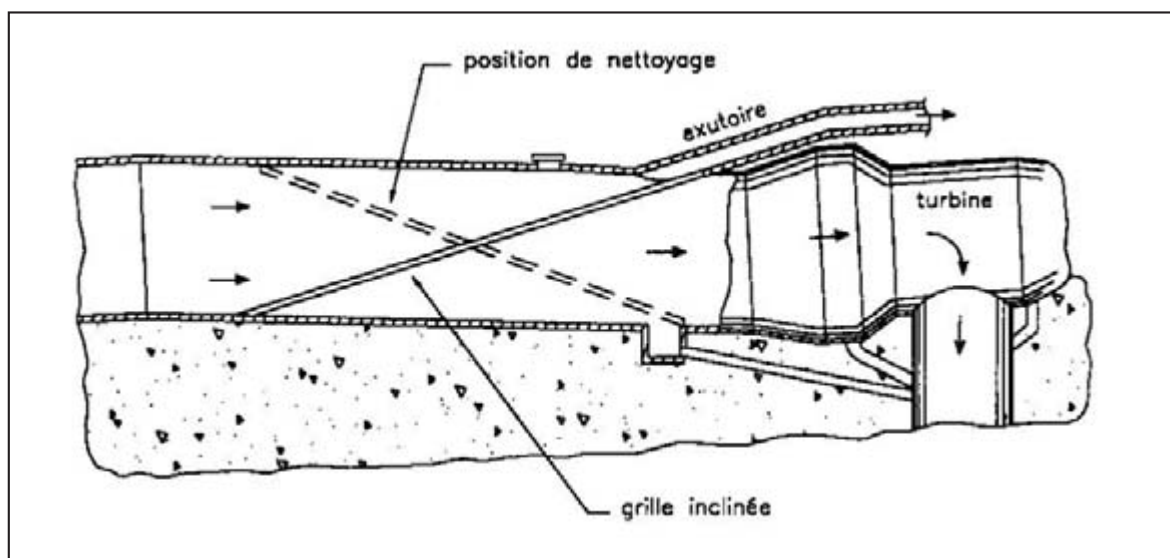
Vue en coupe d'une grille de déflexion de type "Eicher" (EPRI, 1994). Le panneau de grilles (à barreaux de section triangulaire) est monté sur un axe et peut être nettoyé à contre-courant par pivotement.
